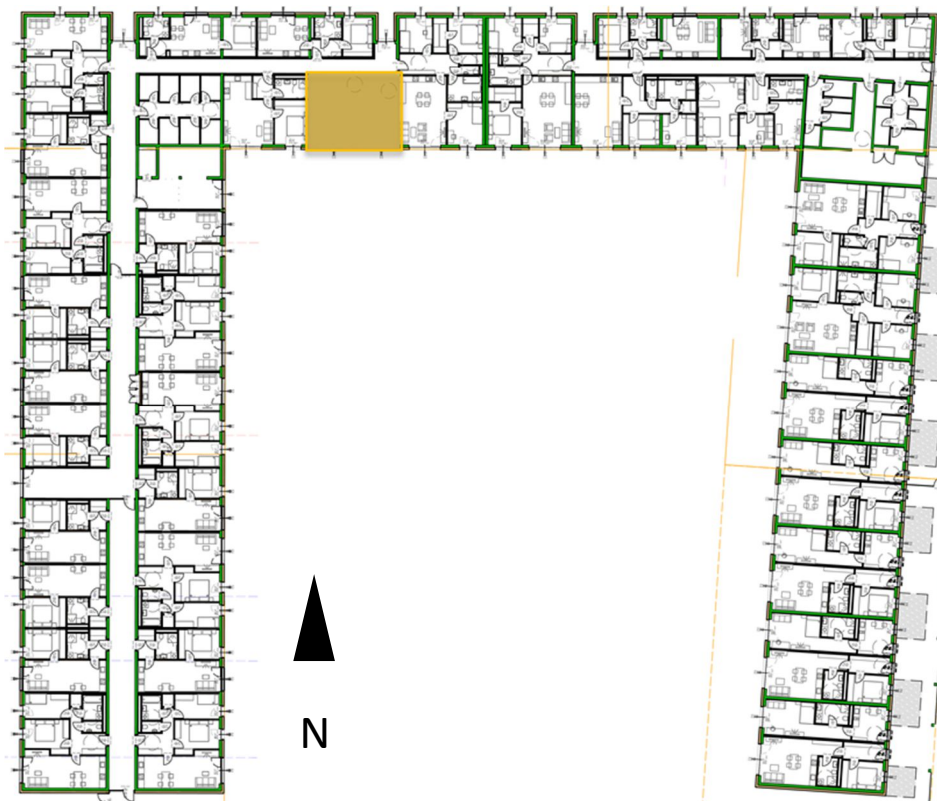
Grundriss Baufeld Mitte 7. OG
